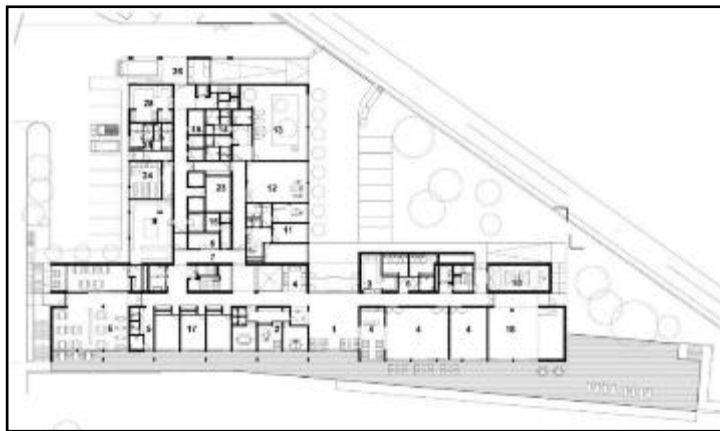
PLANTA DE DISTRIBUCION 2
